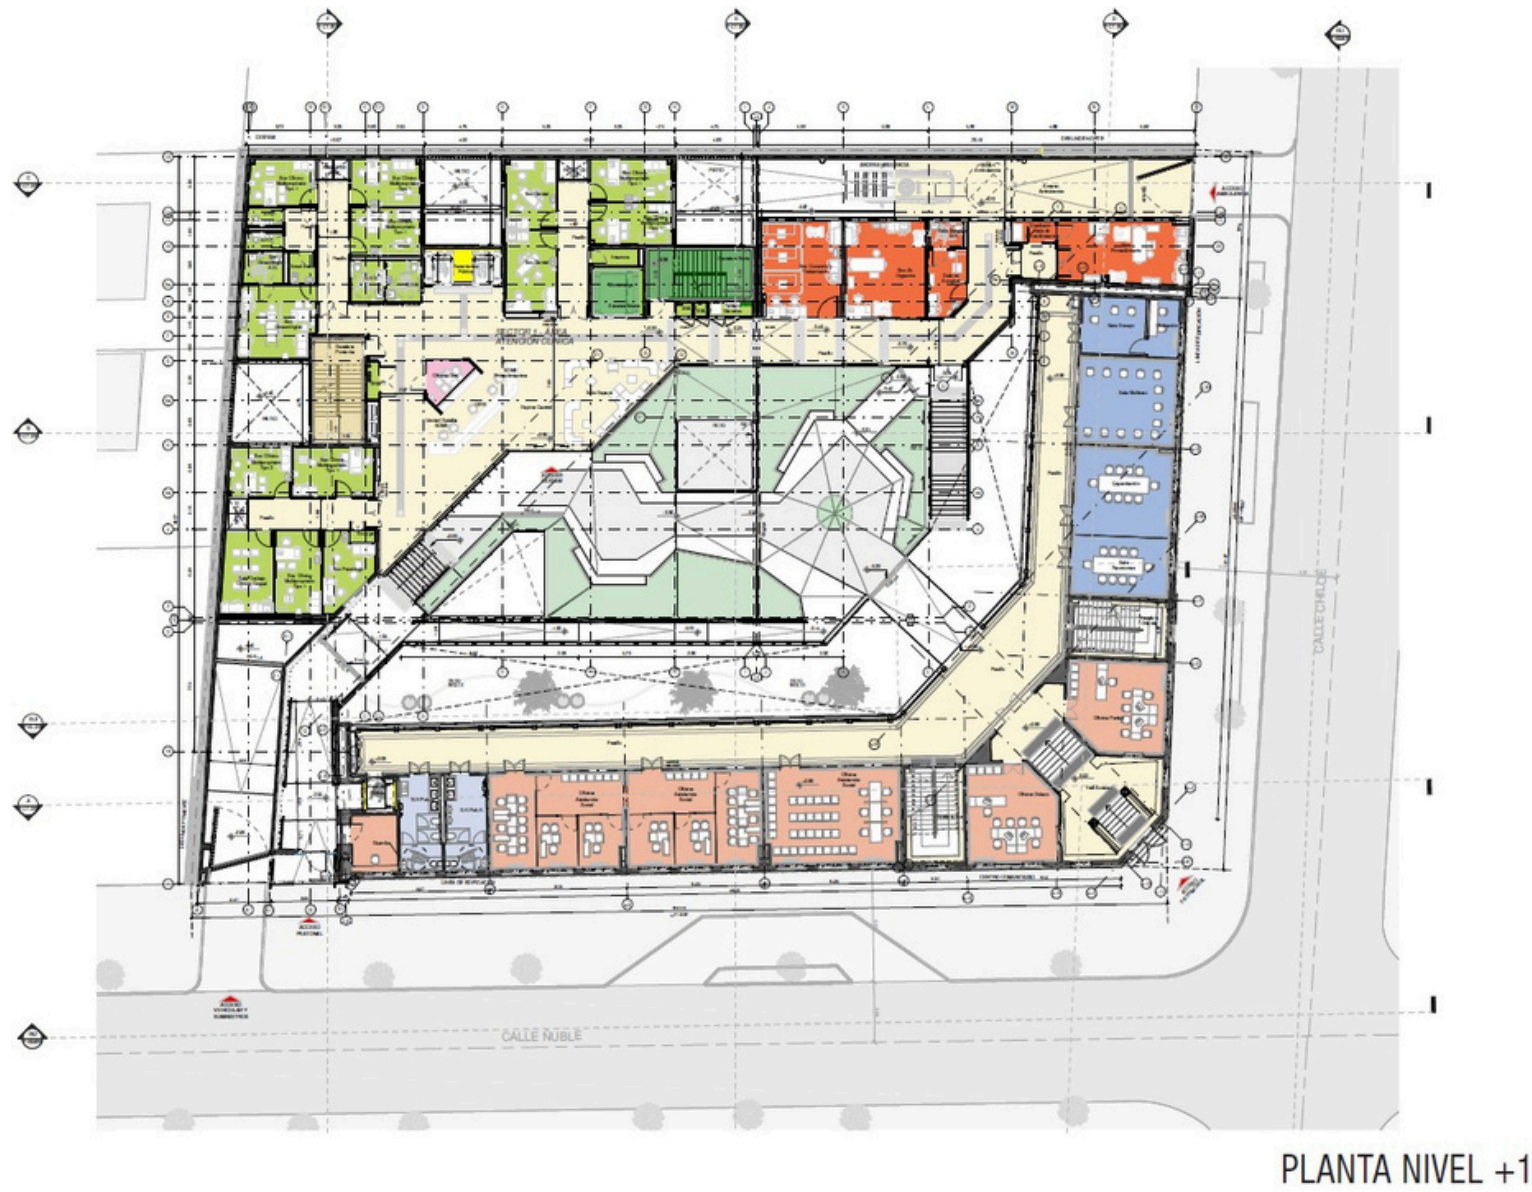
30 Planta Nivel 1. Fuente Luis Vidal + arquitectos
